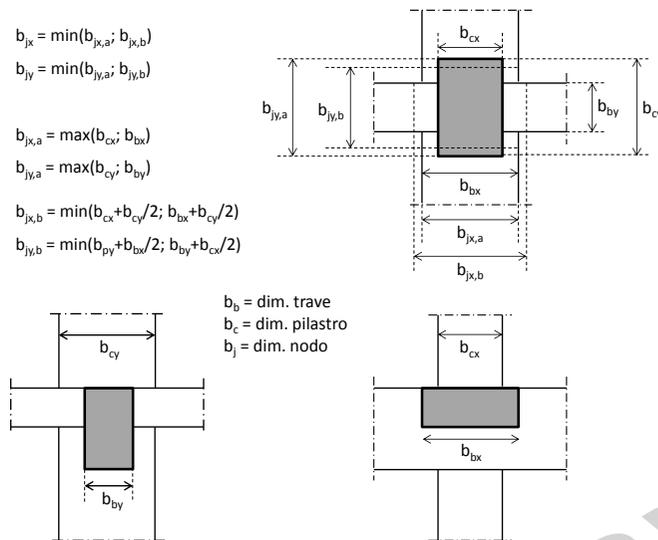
Dimensione efficace dei nodi trave-pilastro
